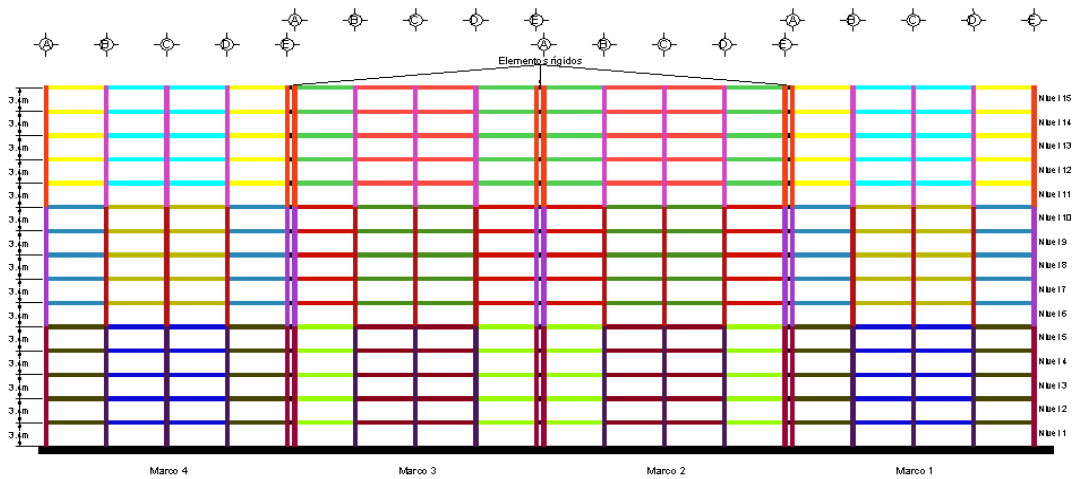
Identificación de refuerzos distintos en columnas y vigas en dirección x, modelo M1Q2CP
